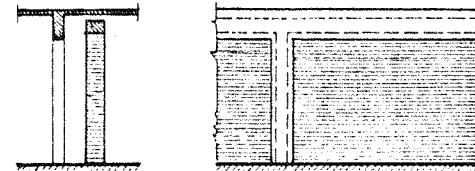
Soluciones para unir rígidamente los muros a la estructura cuando se los construye posteriormente
